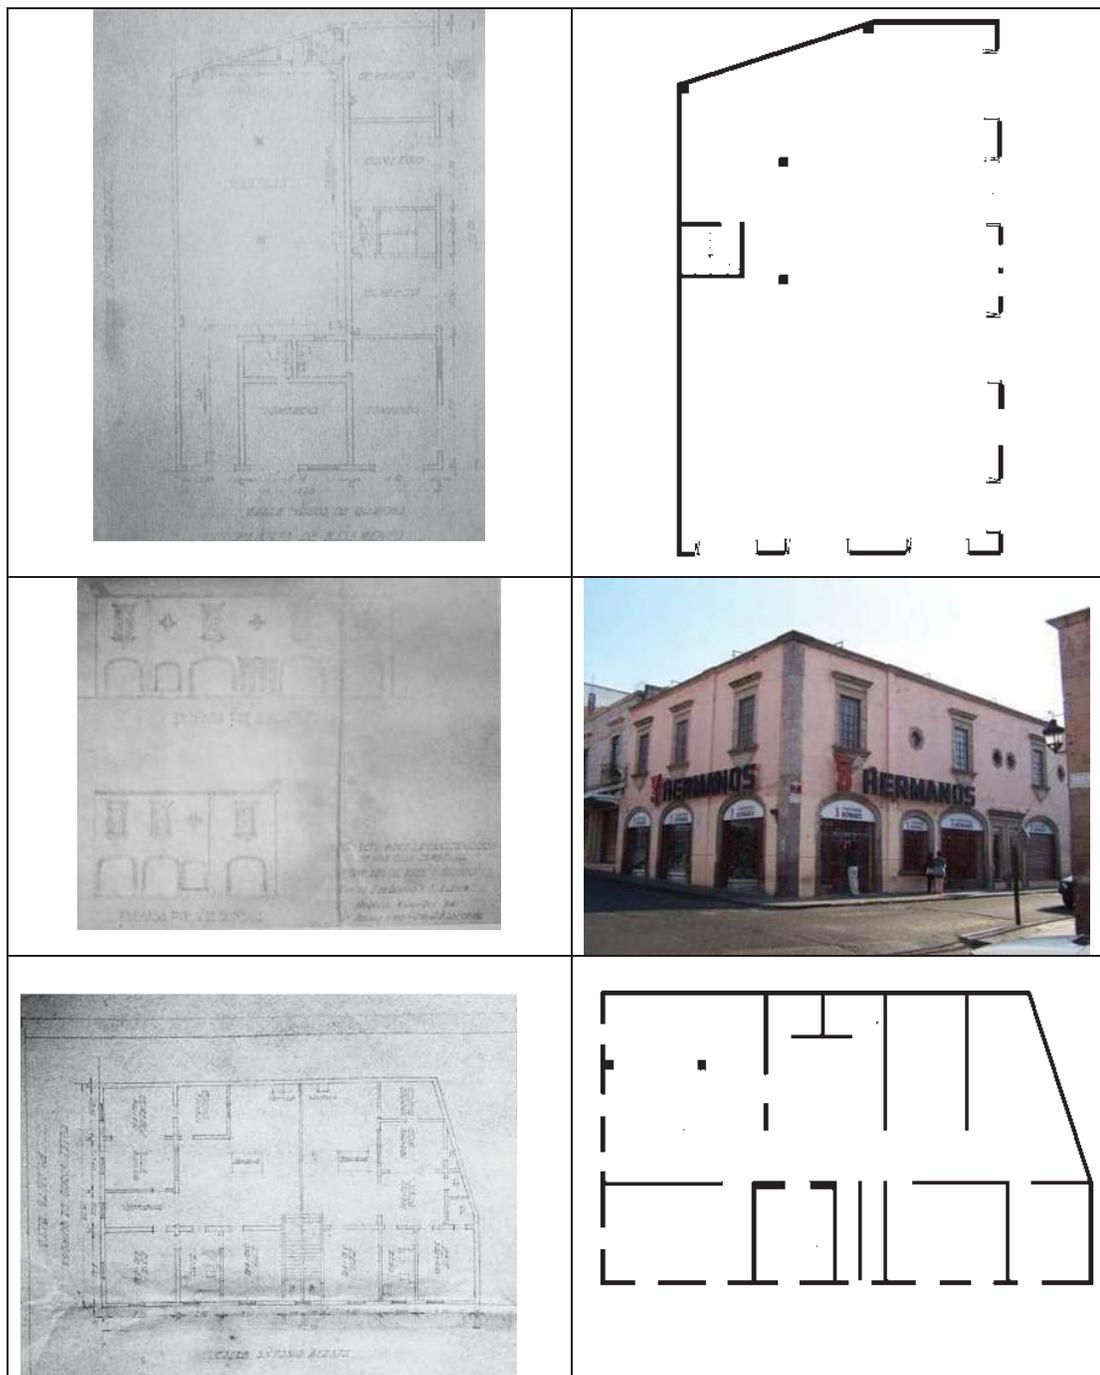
Tabla comparativa entre los planos históricos y el levantamiento actual del edificio. Se pueden apreciar que las modificaciones en fachada son casi nulas, en cambio en planta baja se eliminaron por completo los muros divisorios. Imágenes de archivo cortesía de Catherine Ettinger
